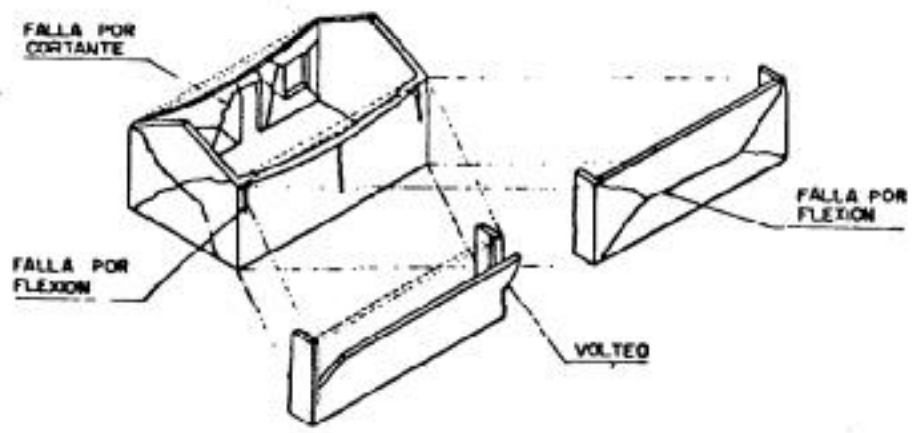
Daños en muros de mampostería (ref. 2)
